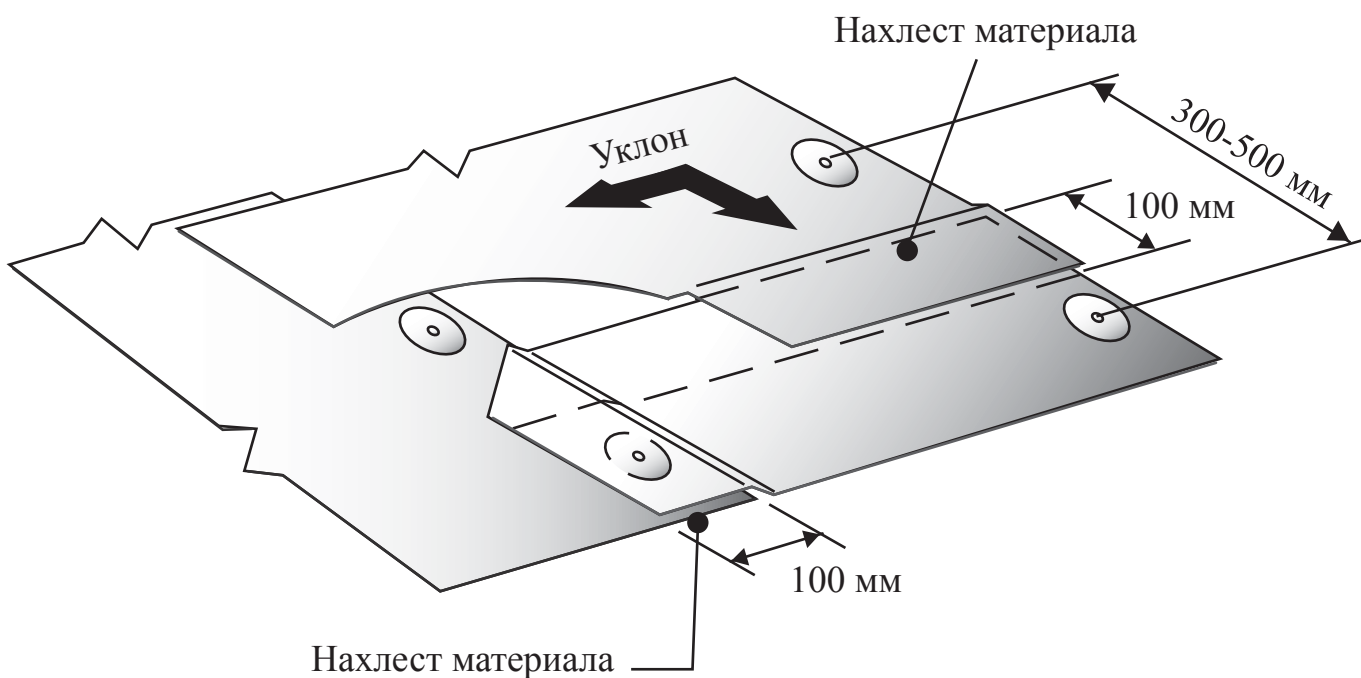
Нахлесты полотнищ кровельного материала при механическом креплении гидроизоляционного ковра.
